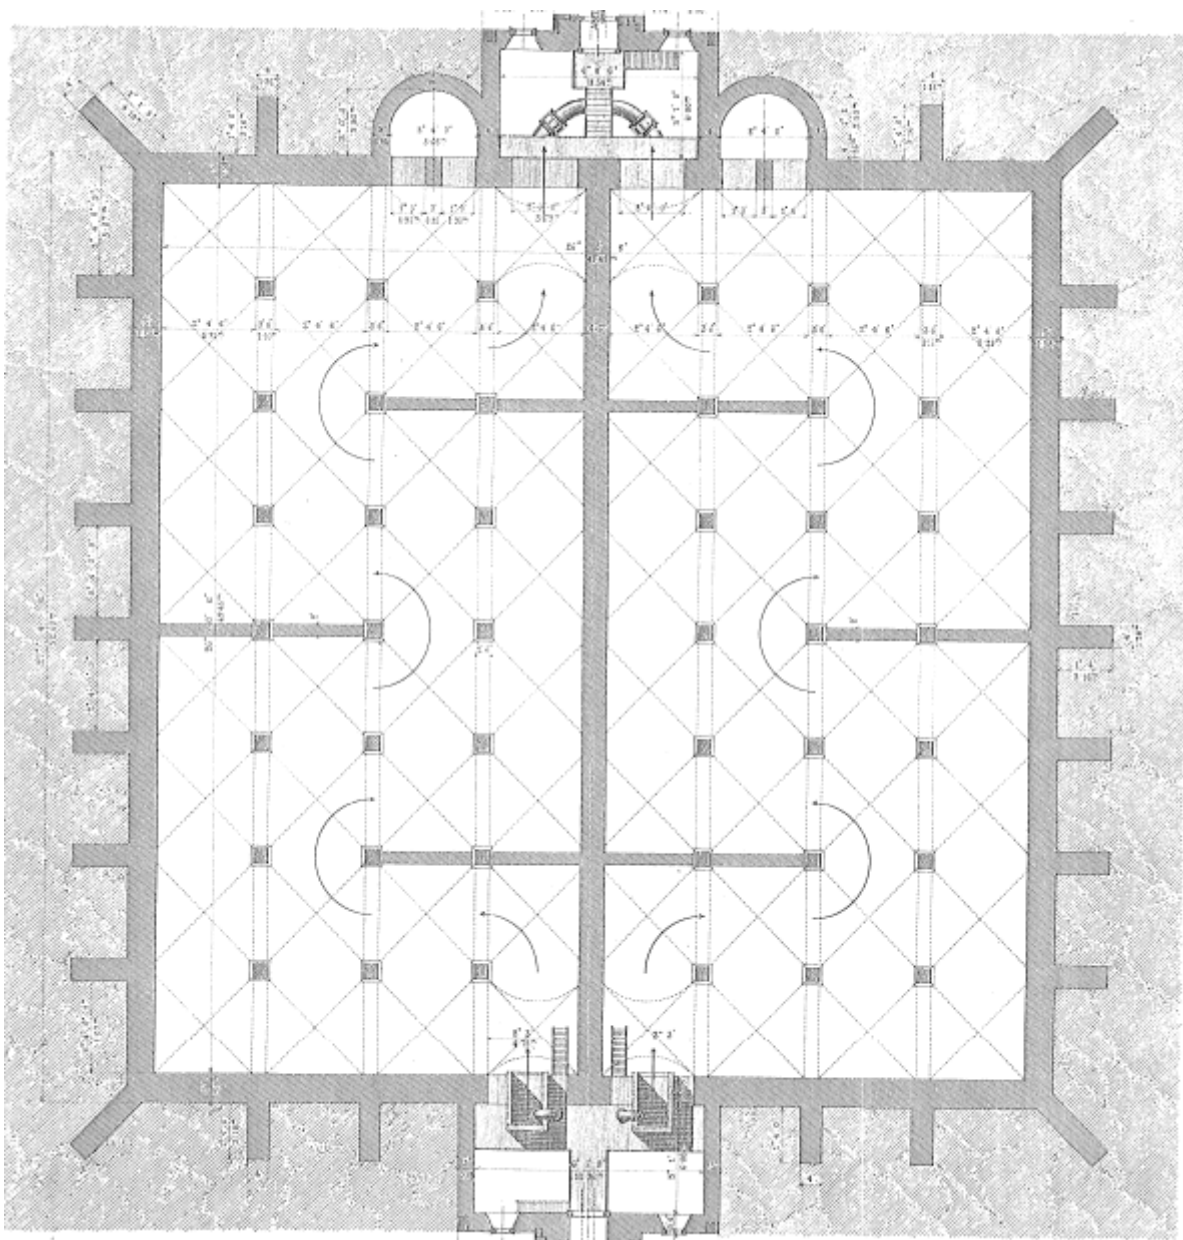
Grundriss der Speicherkammer des Wasserbehälters am Laa'er Berg
